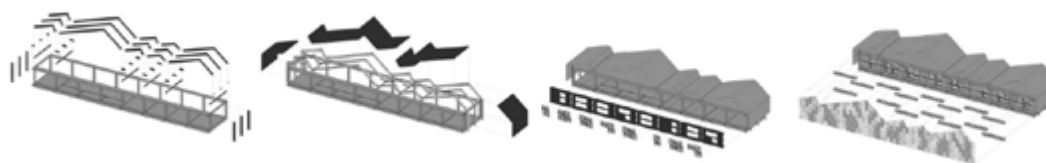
Proceso de montaje de los elementos constructivos de la obra. Autoría: Elaboración propia
